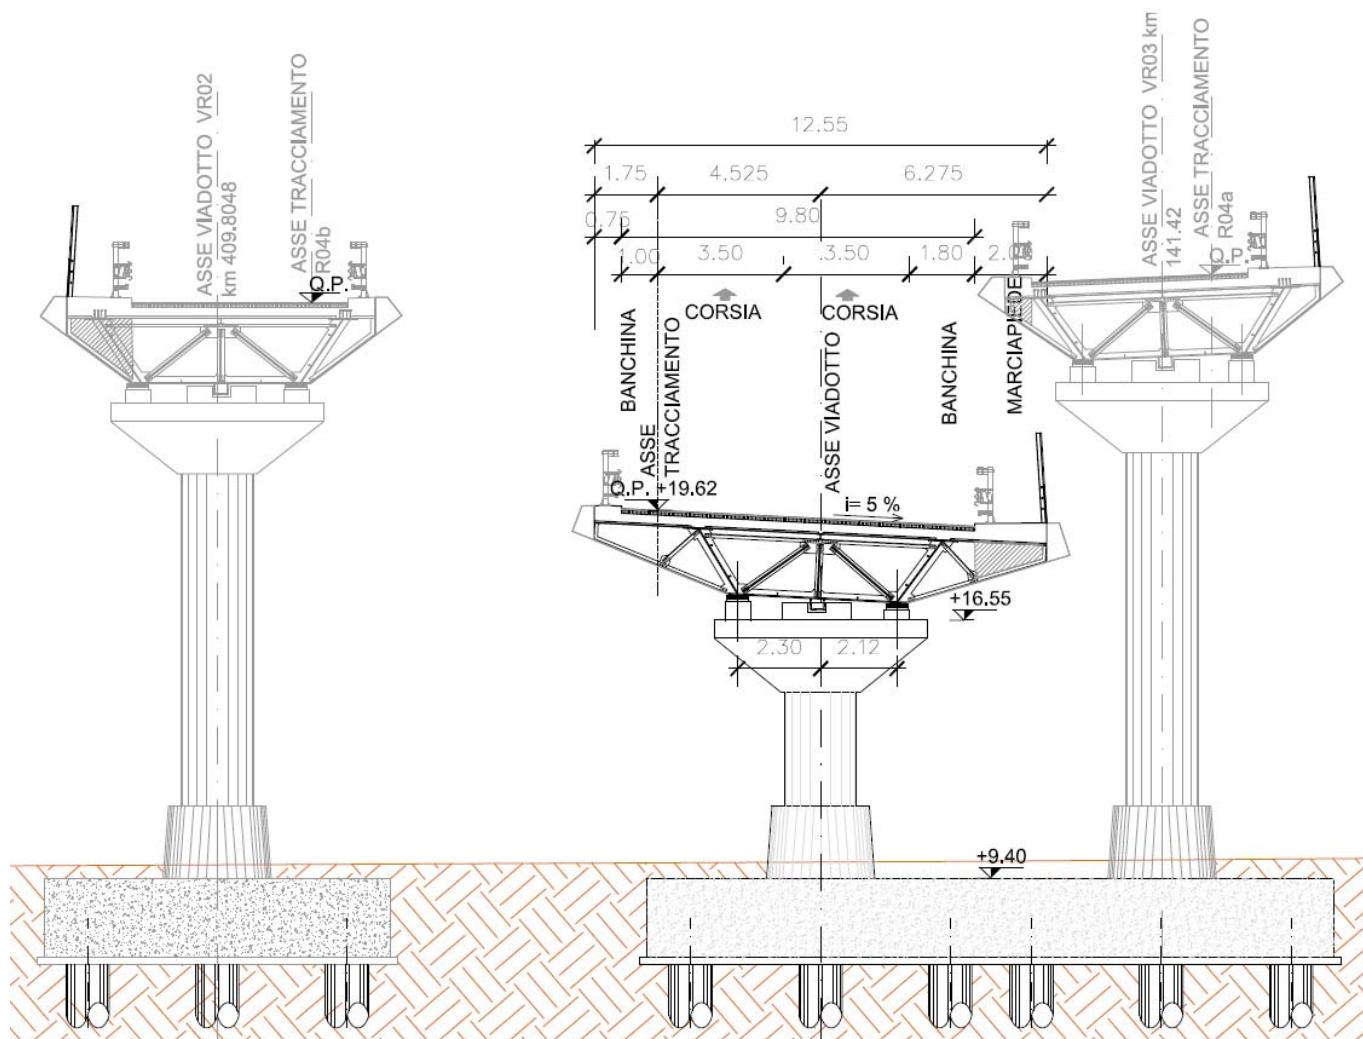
Viadotto VI01 - Sezione trasversale su pila
